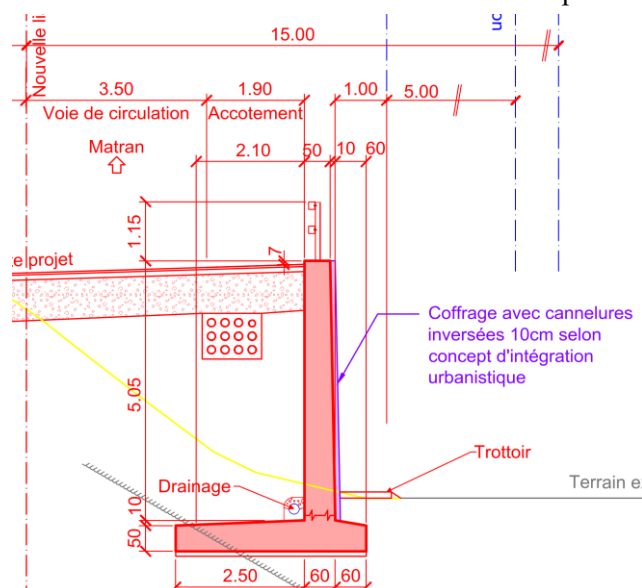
Section type du mur des Fontanettes aval avec fondation superficielle
